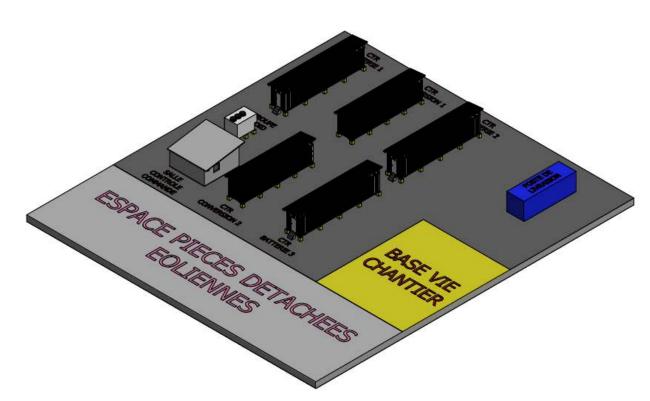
Zone technique - Parc éolien de Grand Rivière
